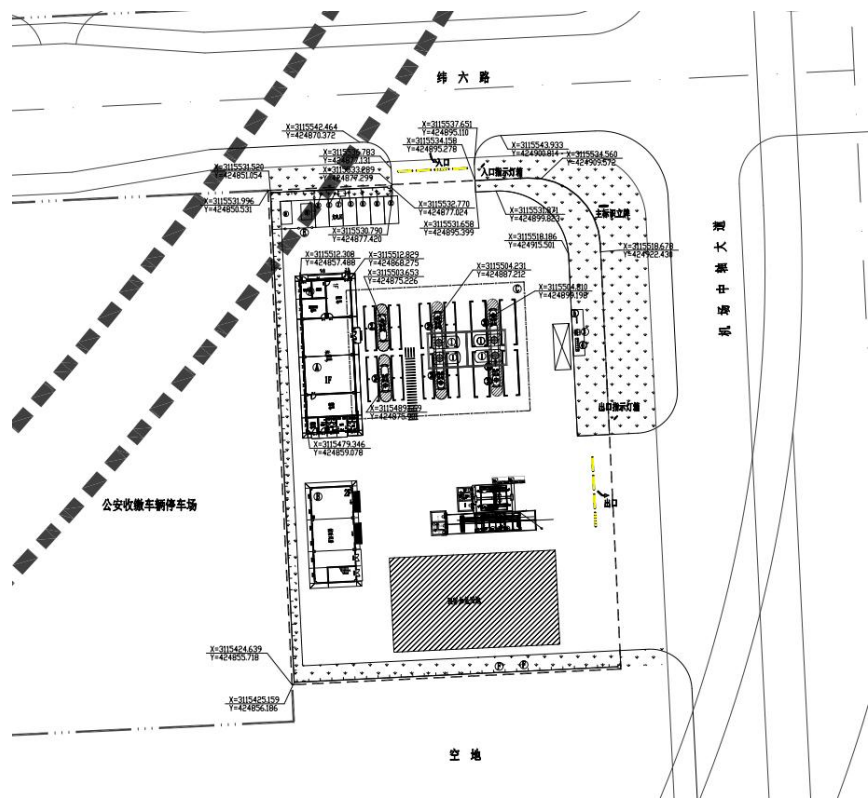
航站区出场加油站总平面布置图（含预留加氢站位置）
